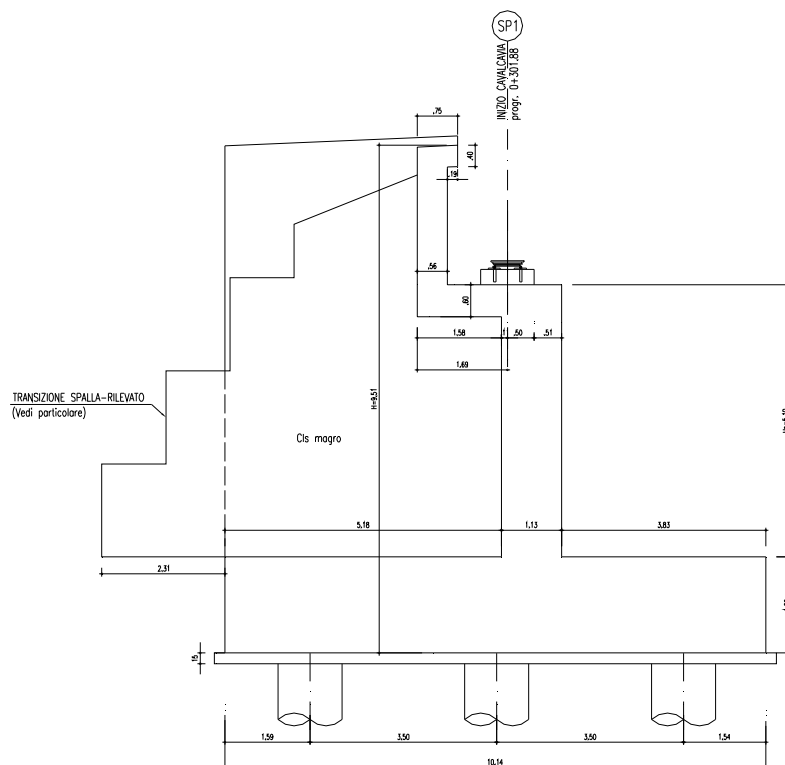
Sezione della spalla (parallelamente al ponte)
